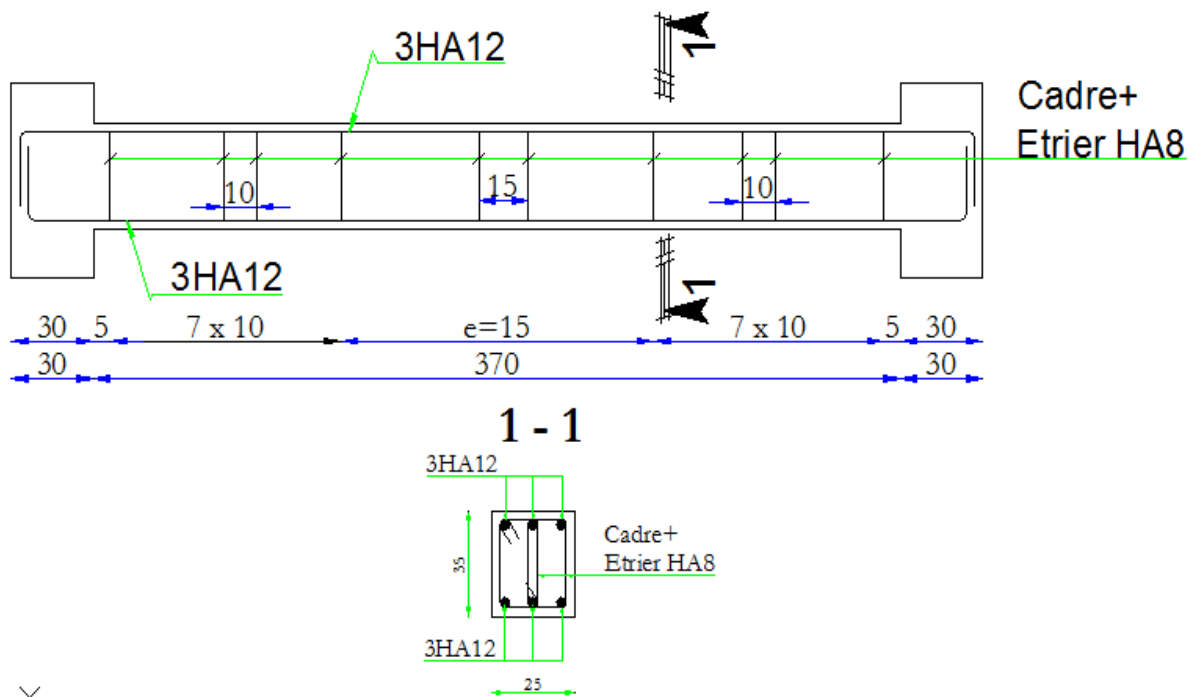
Plan de ferrailage de la poutre de chaînage
